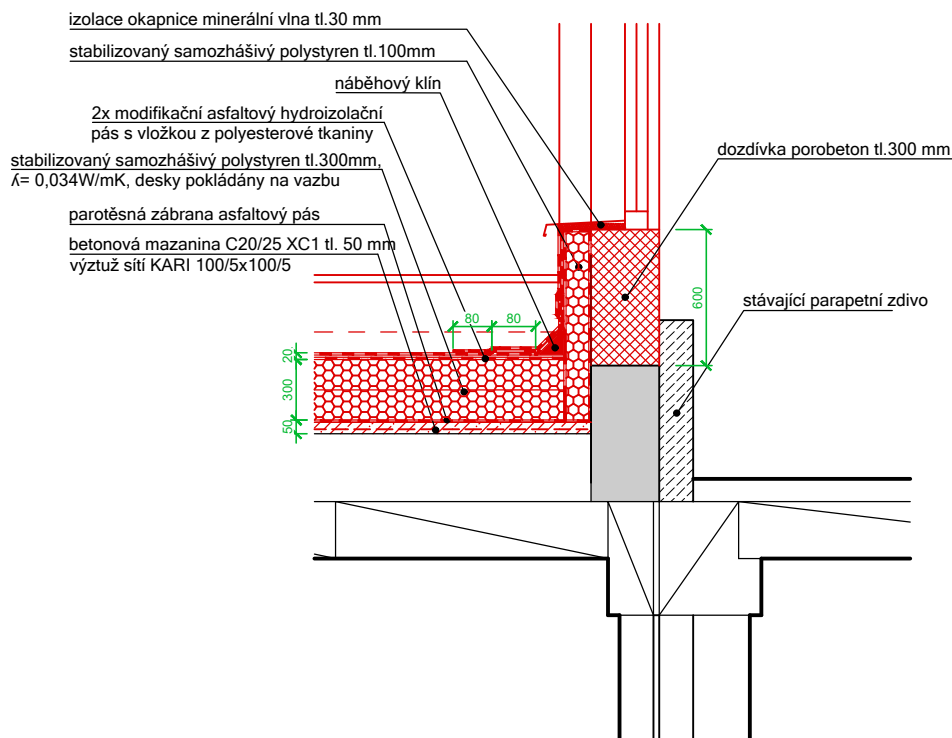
DETAIL D - NAPOJENÍ STŘECHA - PARAPET
